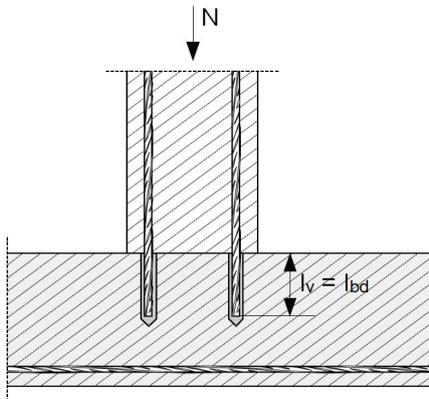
Bewehrungsanschlüsse überwiegend auf Druck beanspruchter Bauteile
